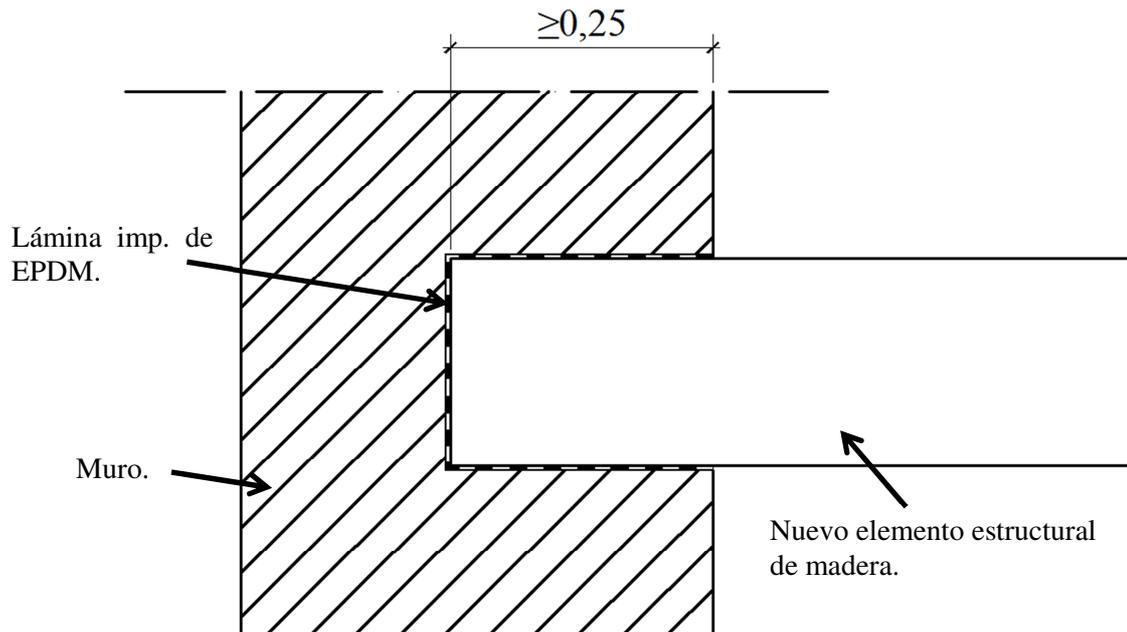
Cabeza del nuevo elemento estructural de madera impermeabilizada.
